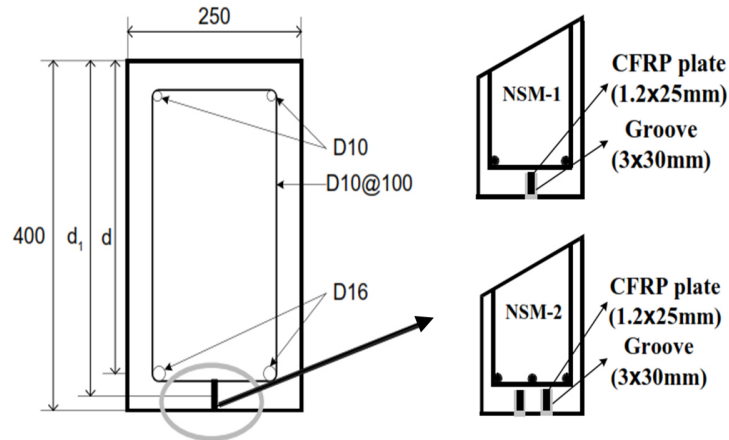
Détails de la section transversale des poutres et emplacement du renforcement.
